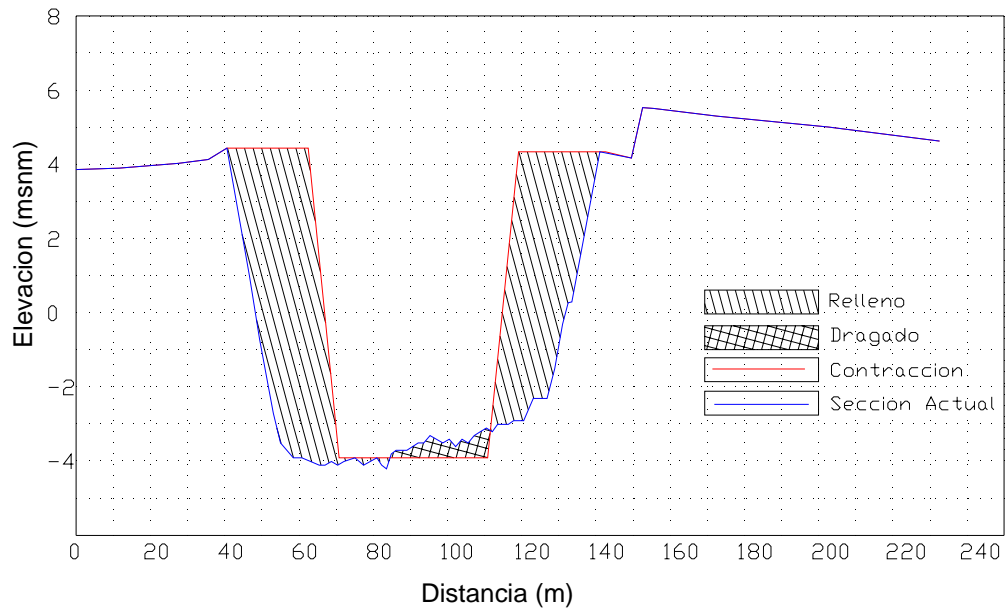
Sección transversal km 47 - Contracción No. 2
